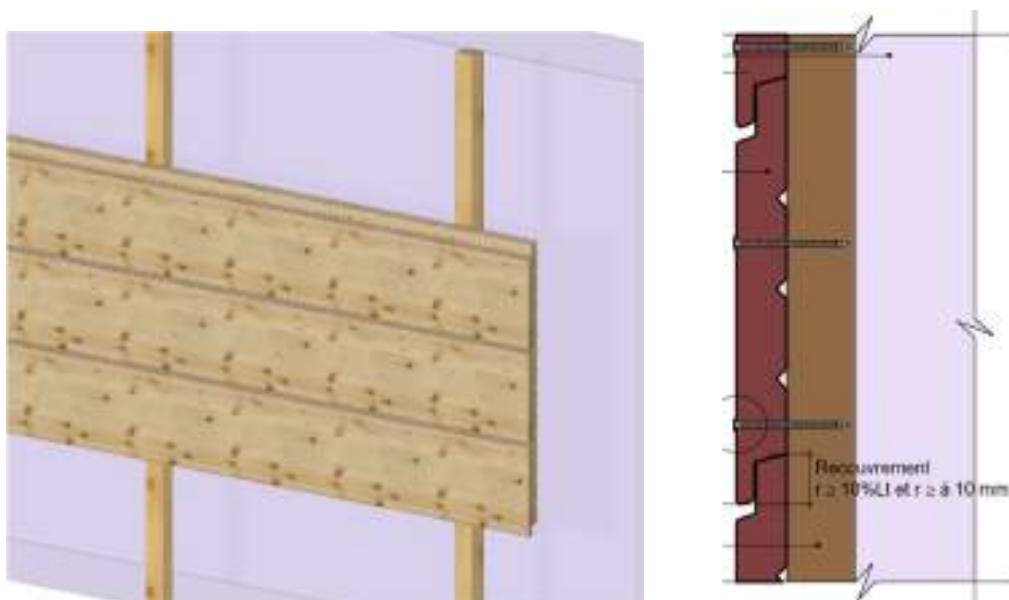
Lames à mi-bois – pose horizontale (illustration 3D et coupe verticale)
